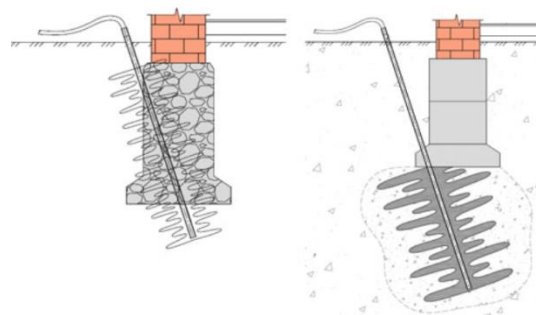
Усиление фундаментов буроинъекционными сваями
